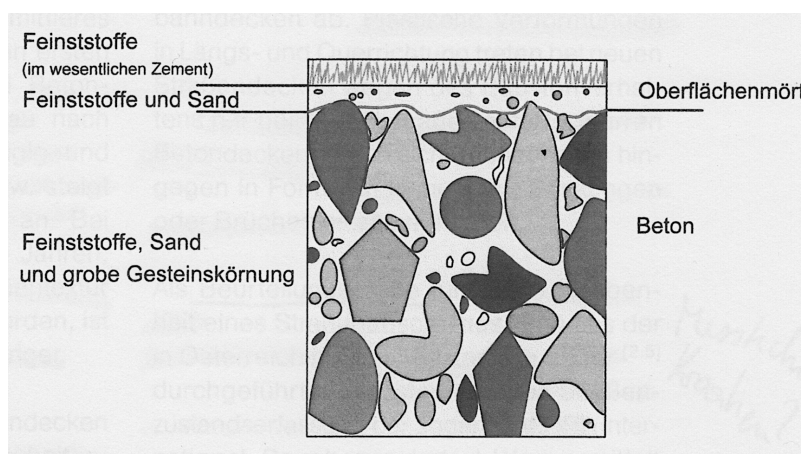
Oberflächennahe Zonen einer Betondecke nach Herstellung (Quelle: Blab 2012: 13)
